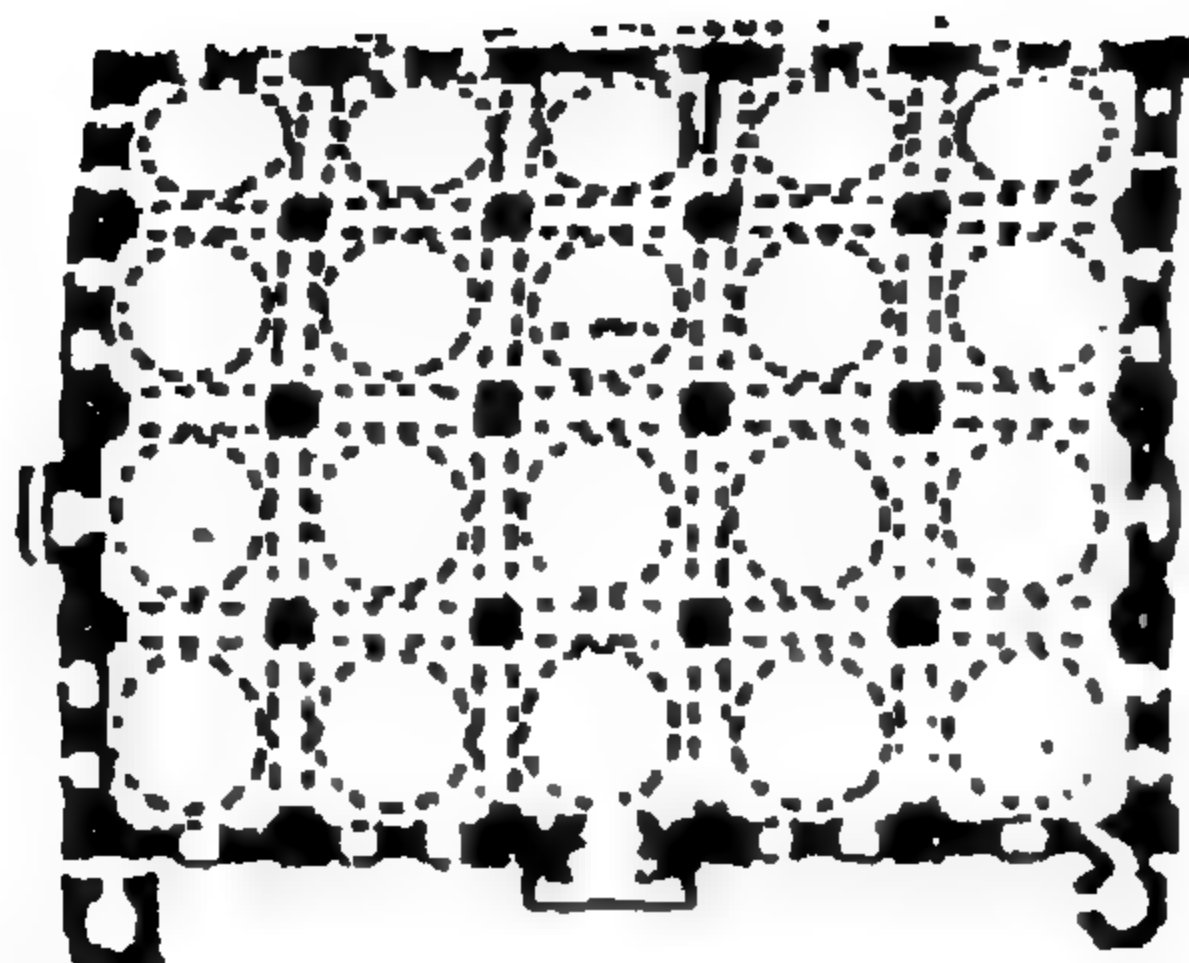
مسقط أفقي لمسجد بلخ في أفغانستان
